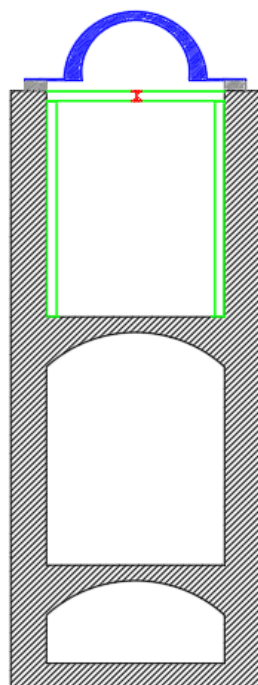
schema tipo sezione del portale in acciaio
